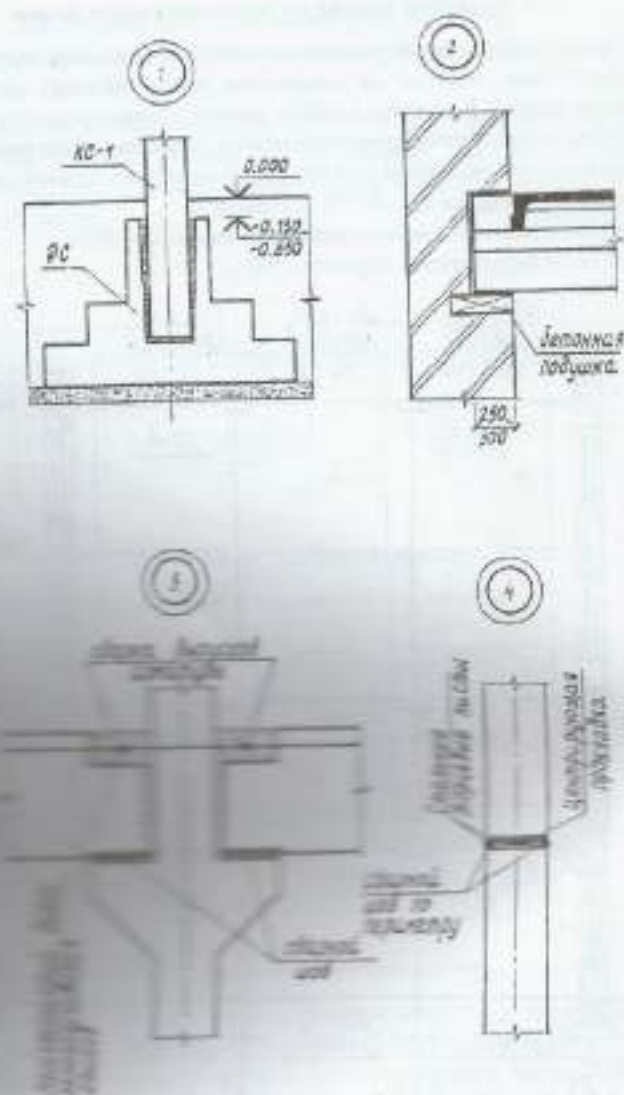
Узлы 1, 2, 3, 4 сопряжения элементов каркаса
